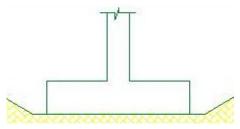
Zapata descubierta (fuente: http://theconstructor.org)
